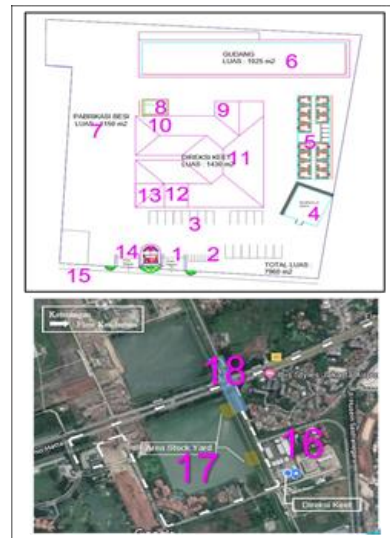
Work Breakdown Structure Pekerjaan Struktur Site layout
